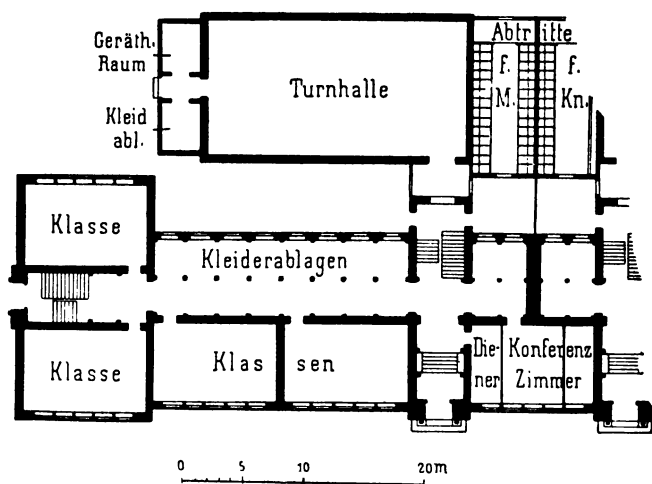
Grundriß der Erdgeschoßhälfte einer 32-klassigen Frankfurter Volksschule.
